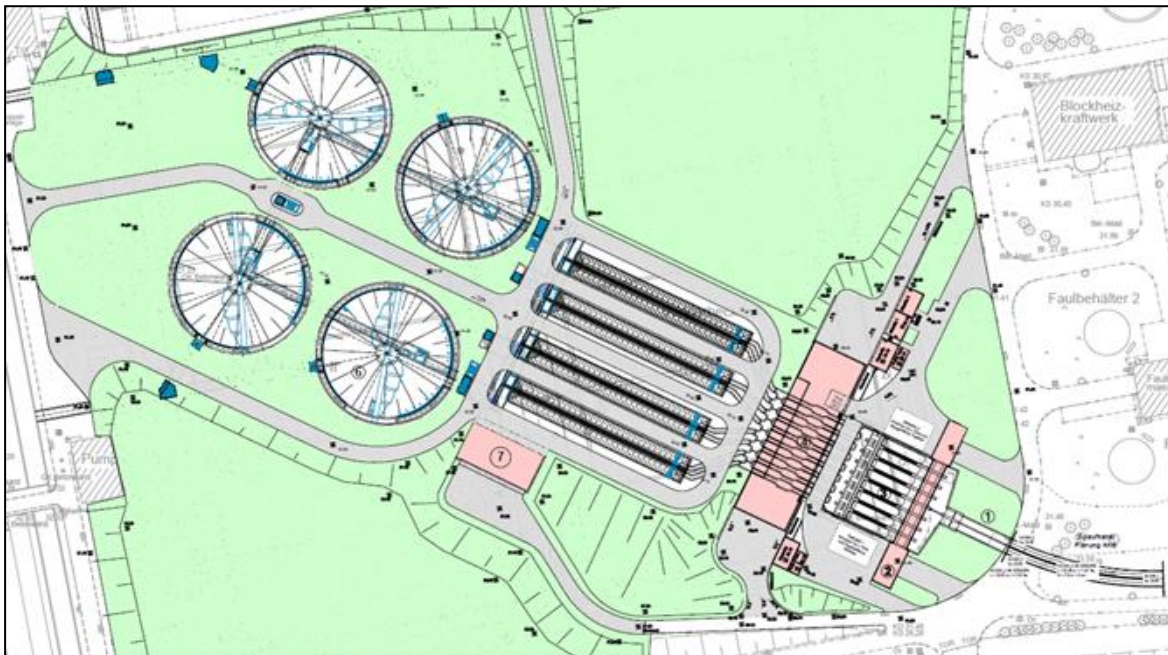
Vorzugsvariante Neubau Mechanik, Übersichtslageplan KLEM
